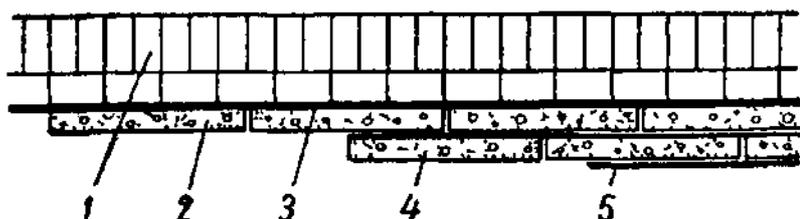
Изоляция стены двумя слоями пенобетонных блоков:
